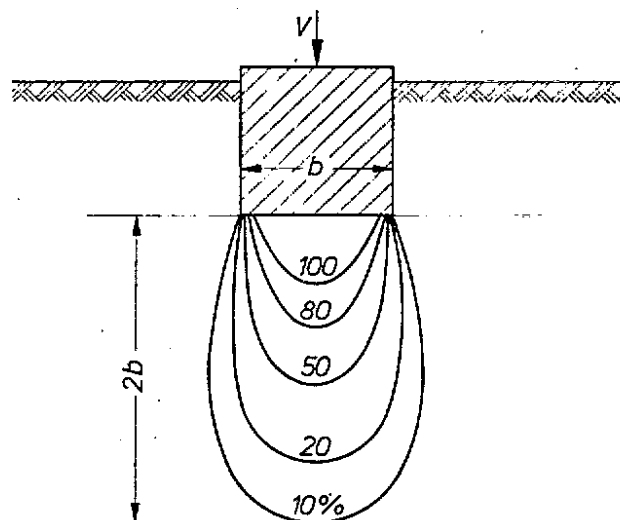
Abbau der Bodenpressung unter einem Einzelfundament
